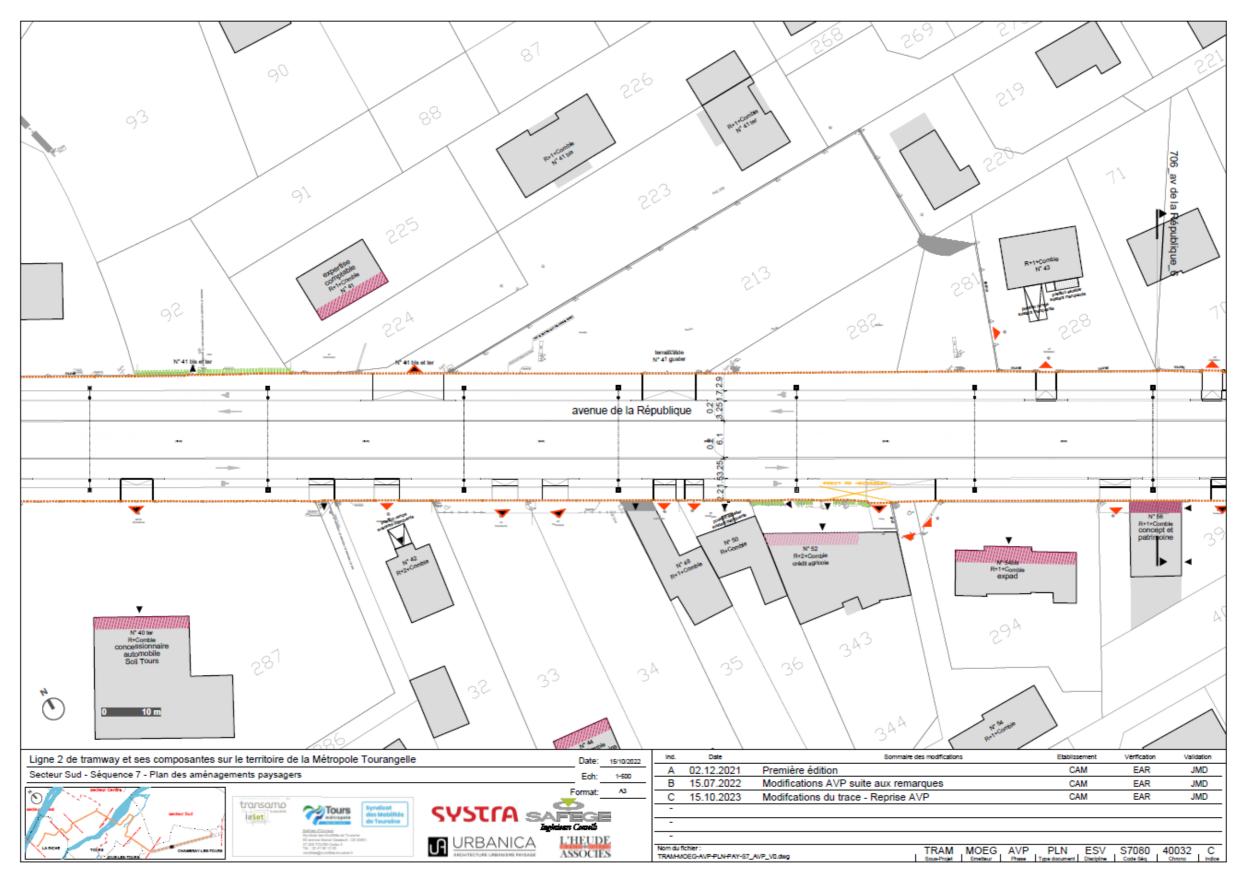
plan masse de localisation des arbres à abattre sur avenue de la République – Section 2 (planche 8)
